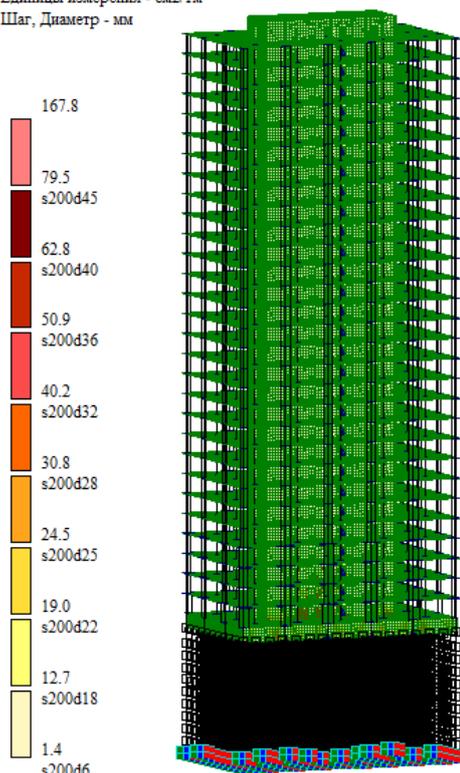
Схема армирования внутренней части стен по оси OY
